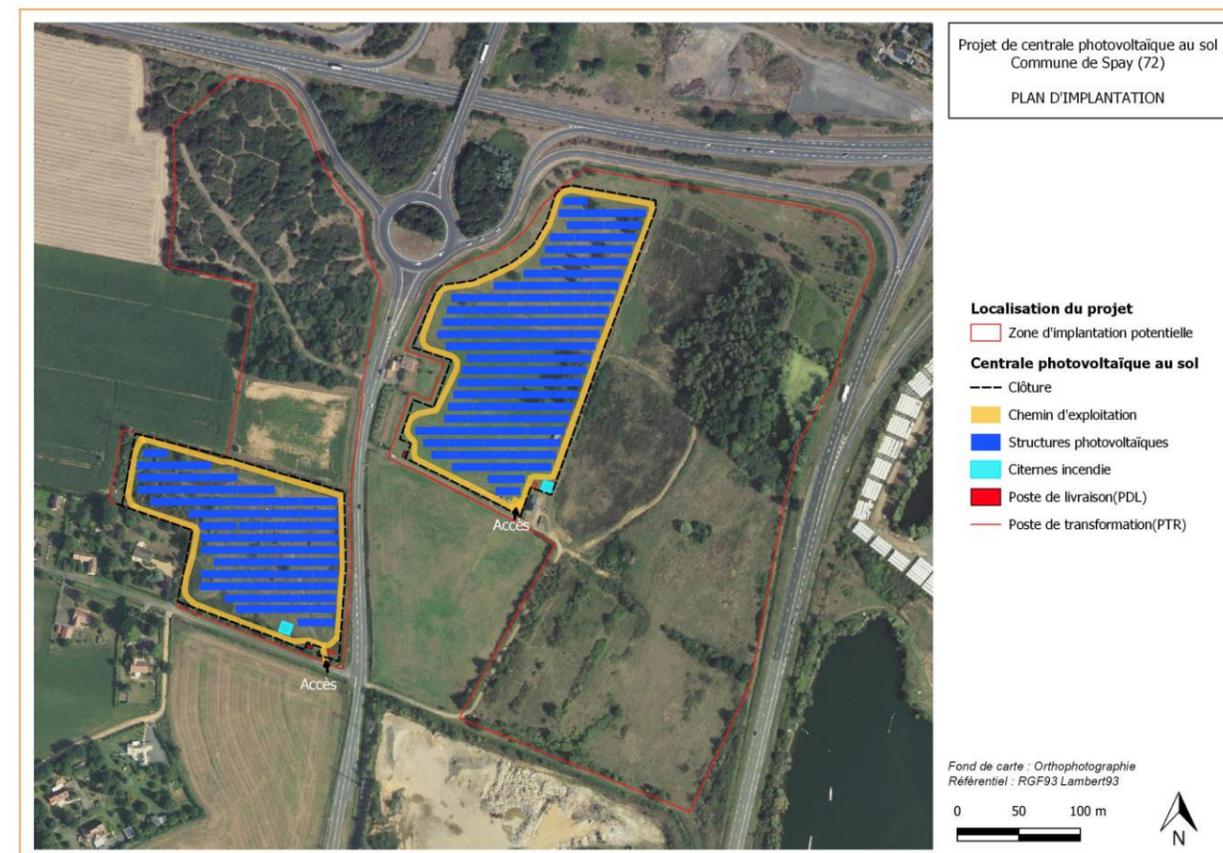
Plan d'implantation général de la centrale photovoltaïque
